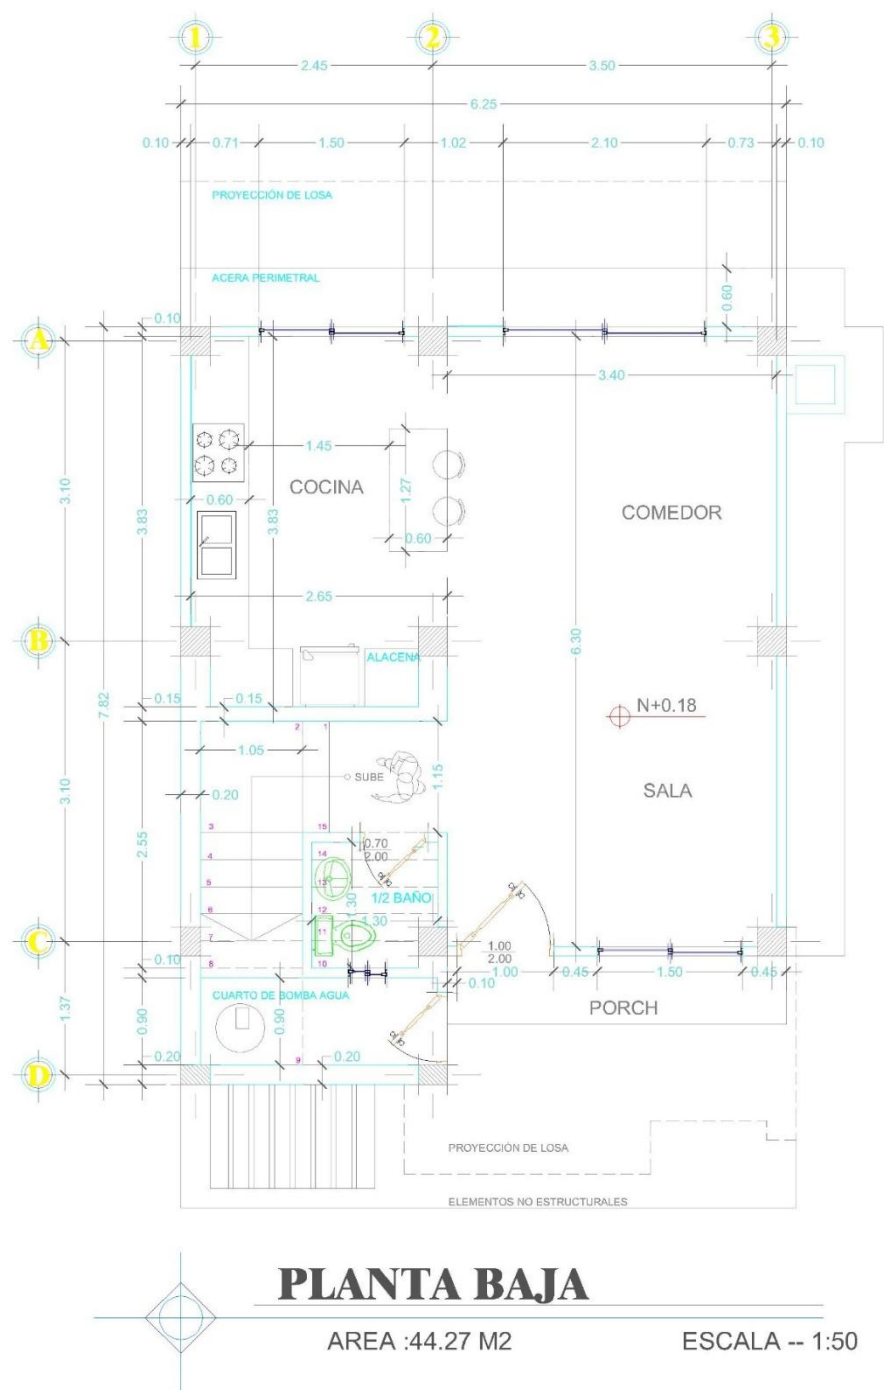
Planos arquitectónicos vivienda de hormigón armadoNota.* Proporcionado por arquitecto de la vivienda.
